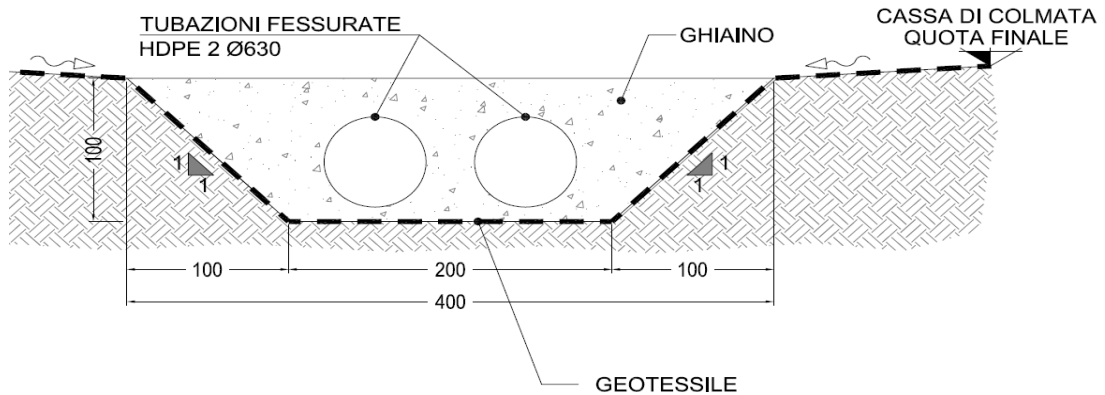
p: Cassa di Colmata – Sezione Tipologica della Trincea Drenante
